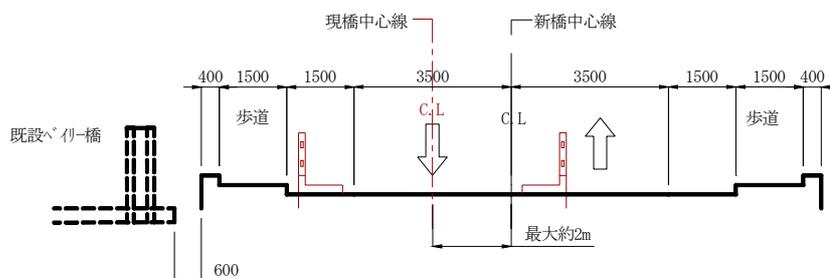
プレックハウ橋架設位置断面図
